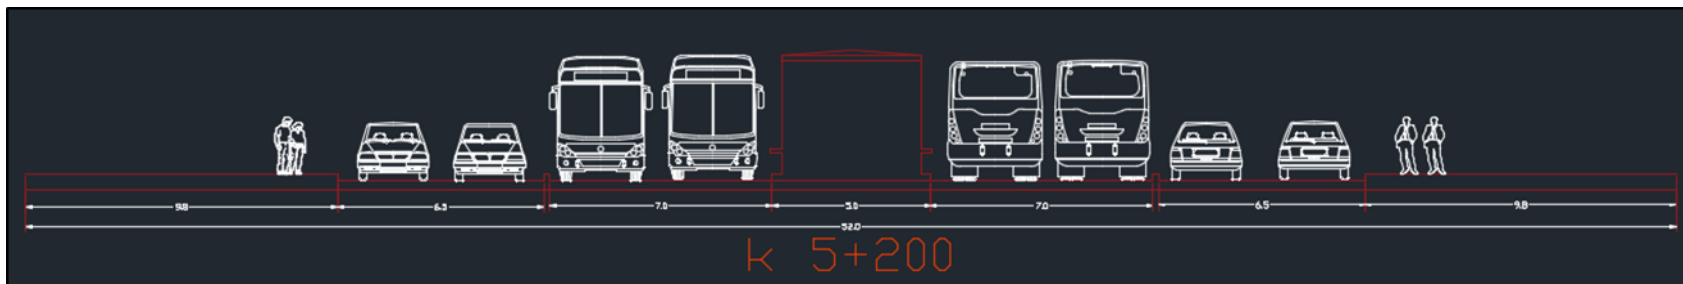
Estación Calle 40 sur (Carrera. 14 con calle 41 b sur)
